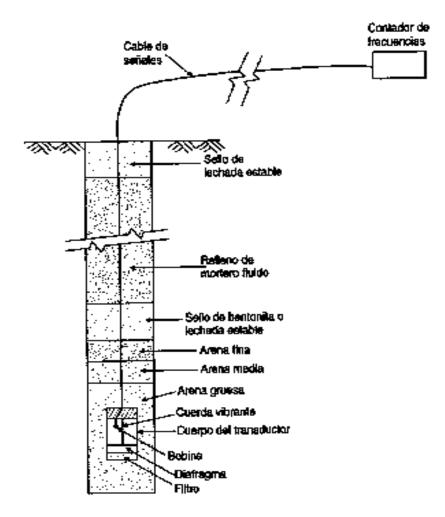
III.3.1.2.2 Piezómetro eléctrico con transductor de cuerda vibrante.
